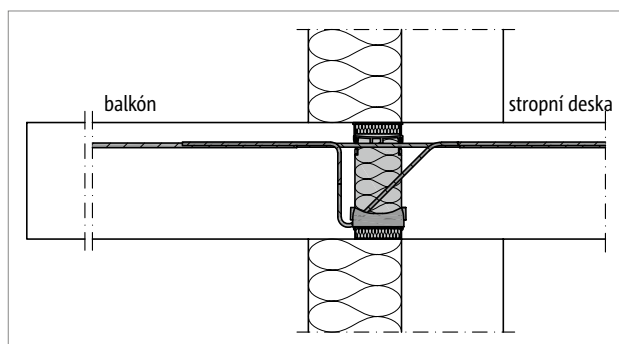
Schöck Isokorb® T typ KL a typ QL: Lodžie uložená ze tří stran
